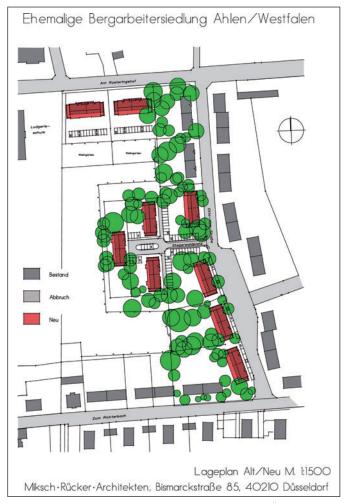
Ehemalige Bergarbeitersiedlung Ahlen/Westfalen. Planung zur Überformung des Siedlungsgrundrisses
